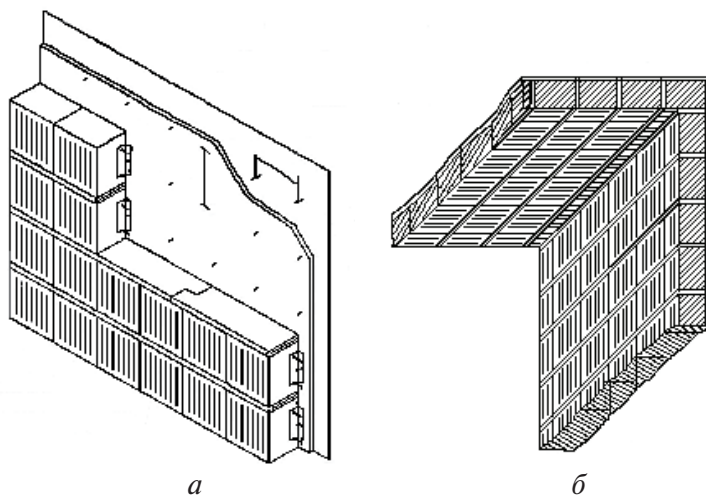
Варианты конструкций теплоизоляционных футеровок с использованием Z-блоков
